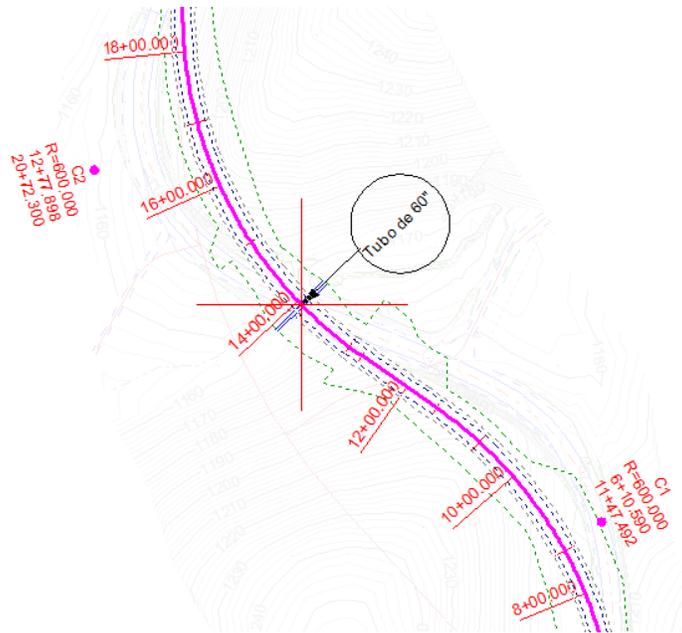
Etiqueta de Obra de Drenaje Transversal
